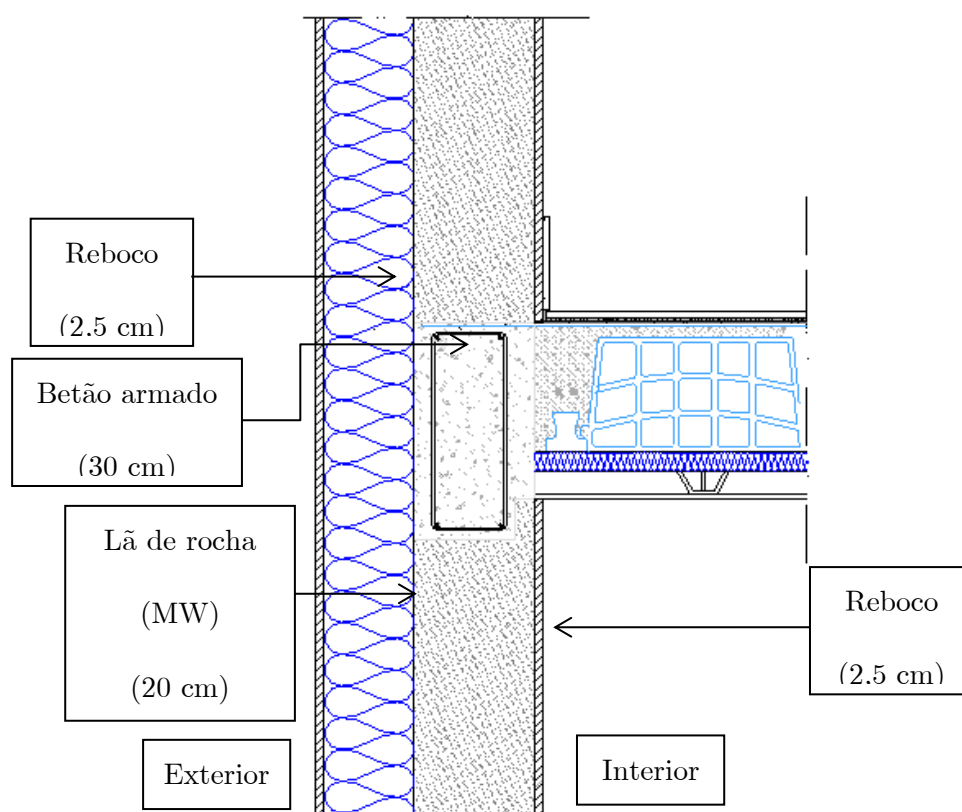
Pormenor construtivo das vigas (N<sub>4</sub>)
